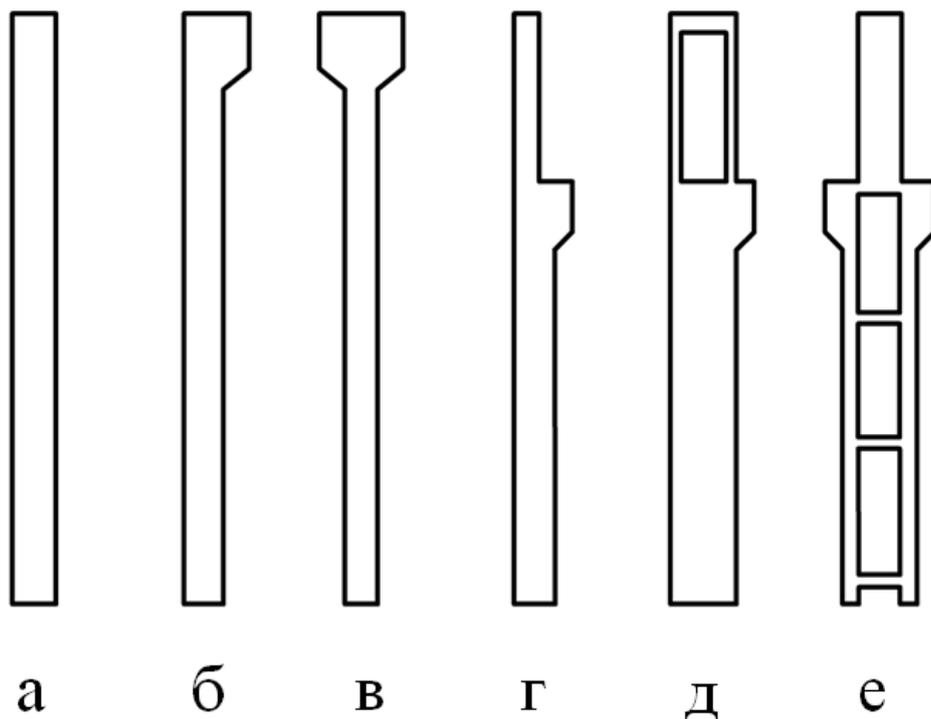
Виды железобетонных колонн для одноэтажных промышленных зданий: а – колонна бесконсольная; б – колонна одноконсольная; в – колонна двухконсольная; г – колонна крановая одноконсольная; д – колонна крановая с проходом одноконсольная; е – колонна сквозного сечения (двухветвевая) двухконсольная
